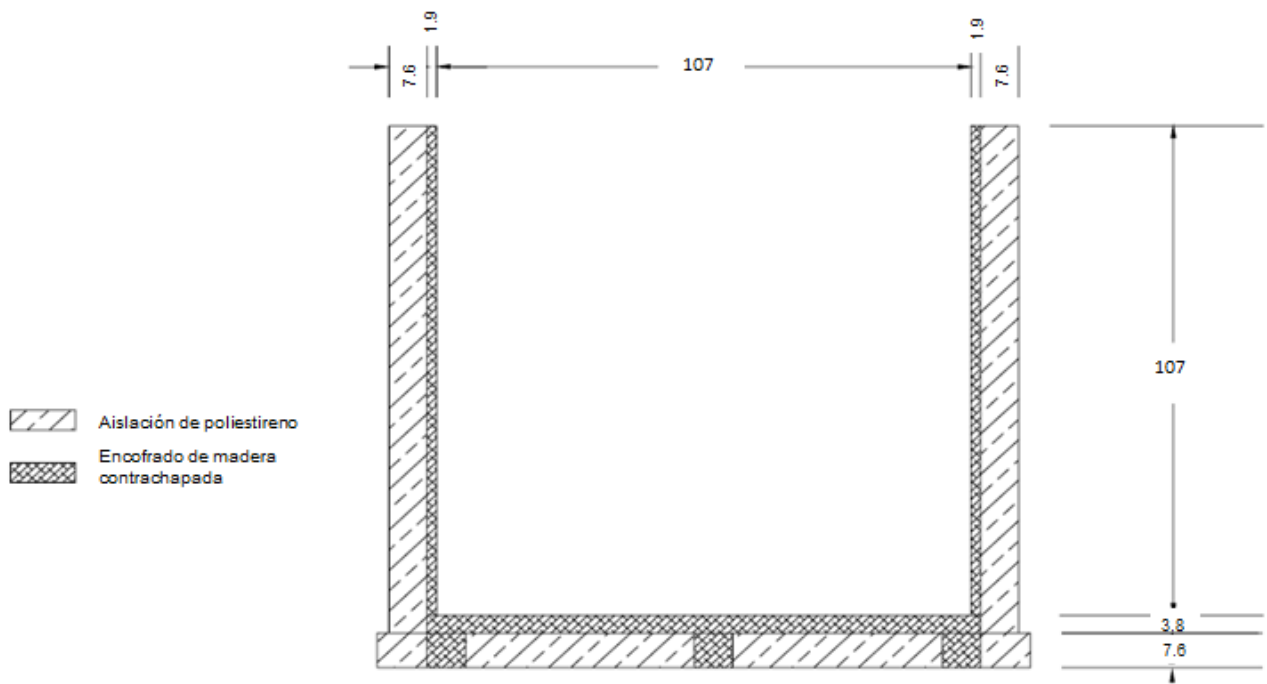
Vista en corte del bloque de hormigón con el encofrado y la aislación térmica (Unidades en centímetros)
